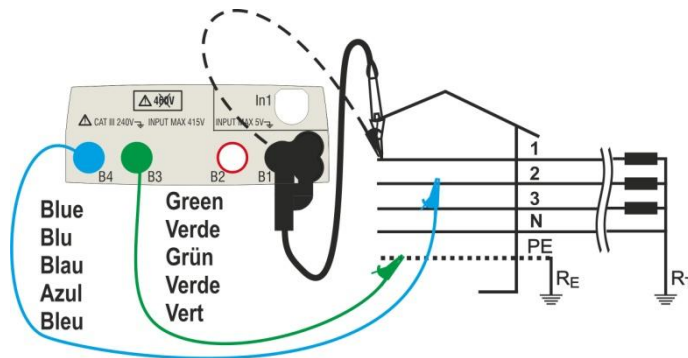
Medição P-P em instalações trifásicas 400V + N + PE
